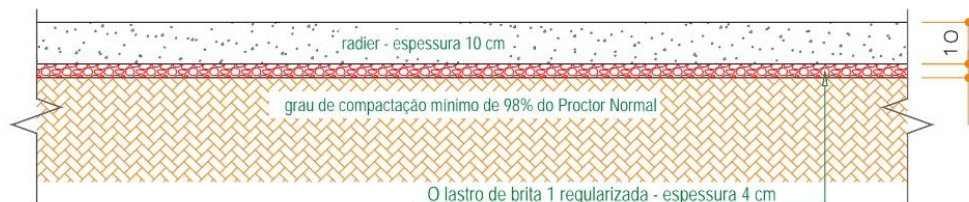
Corte genérico da seção transversal do conjunto *radier*/lastro de brita/terreno natural, corte ou aterro.
